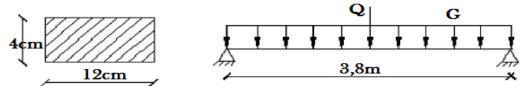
Schéma statique d'une poutrelle avant coulage.
